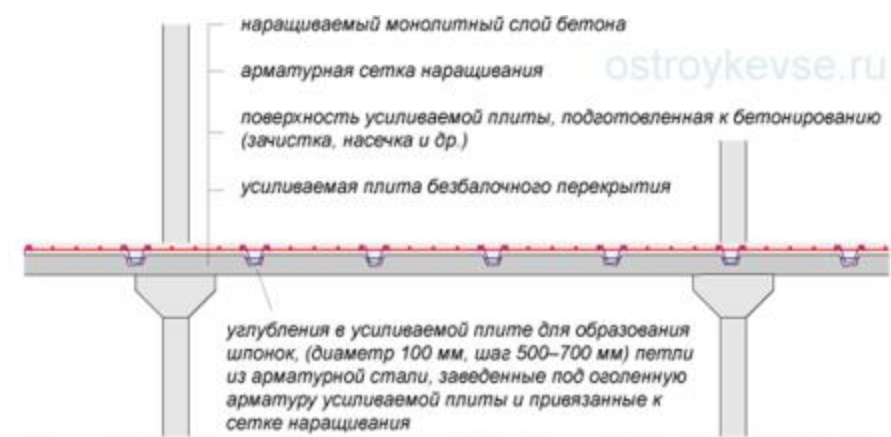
Усиление плиты безбалочного перекрытия наращиванием сверху с устройством шпонок
